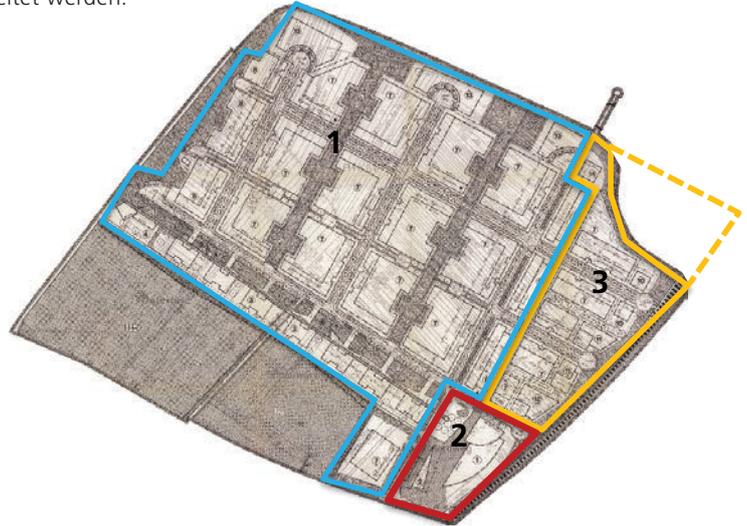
Überlagerung Bebauungsplan und Abgrenzung der Bereiche zur Baurechtschaffung
